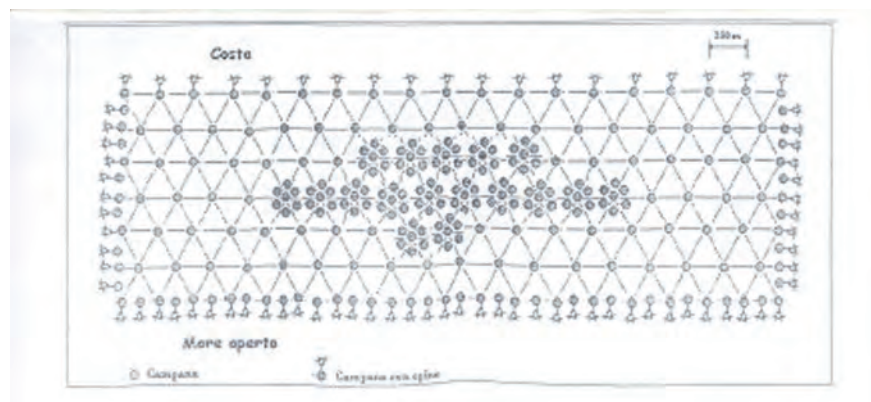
Disposizione a "quinconce" delle campane in calcestruzzo (Foto Carla Giansante)
